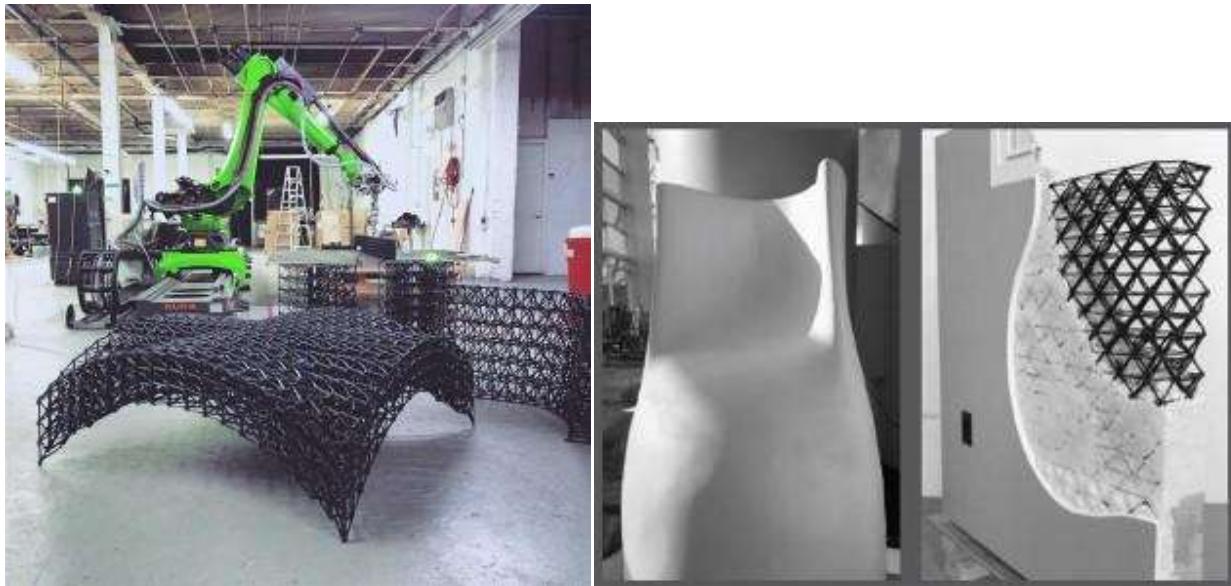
Метод 3D printing C-Fab [3]: а – неметаллический арматурный каркас; б – фрагмент стены
